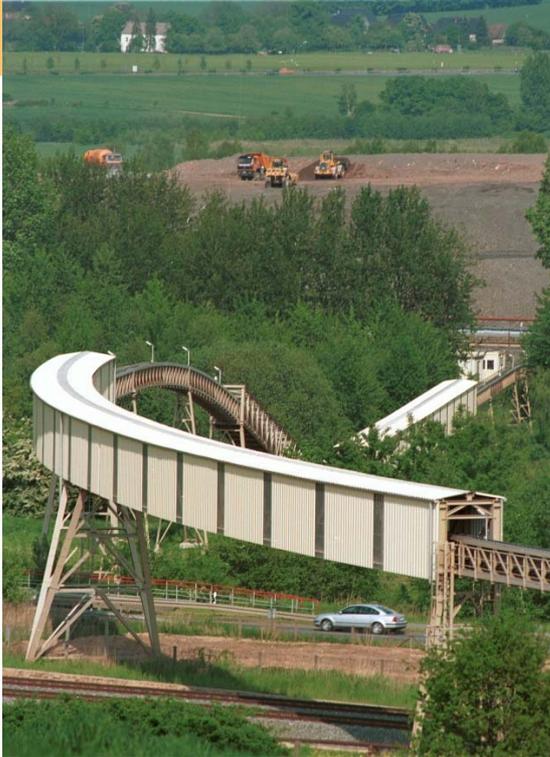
Pipe-Conveyor Crossen, Abtrag Halde Crossen
